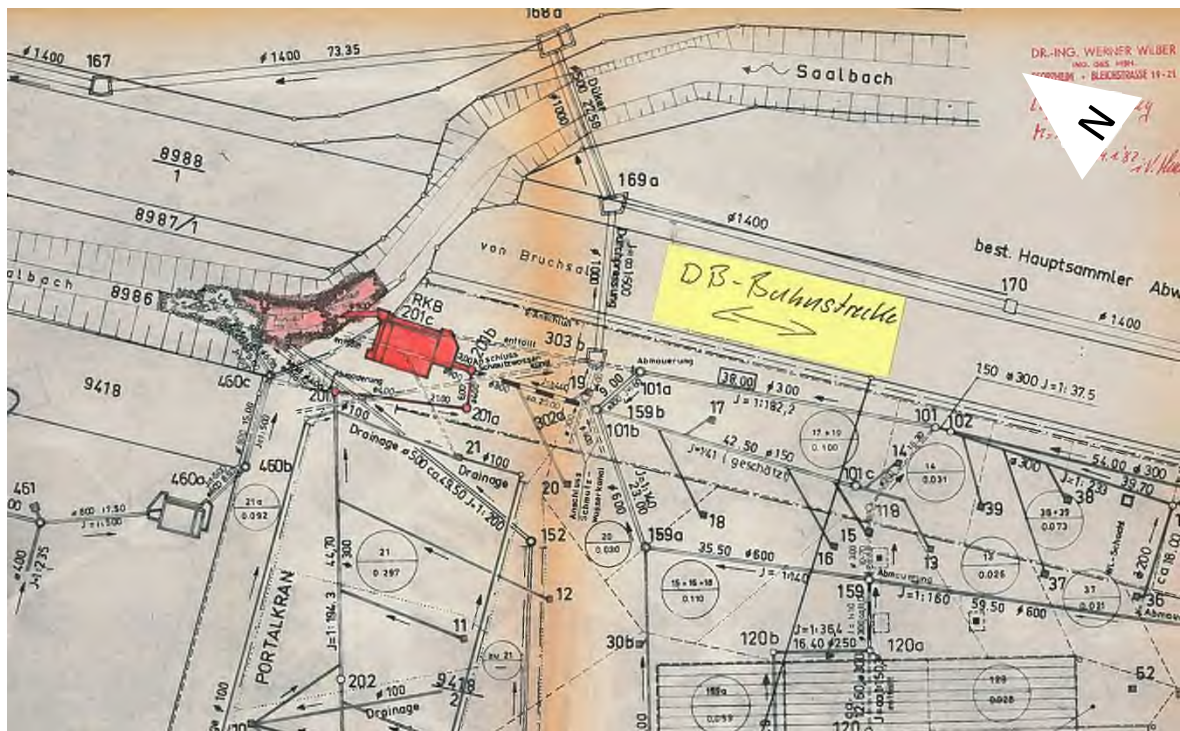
Lageplan mit Bestandskanälen. Erkennbar ist der Hauptsammler nördlich der Bahnlinie sowie das Regenklärbecken am Saalbach (rot hervorgehoben).
